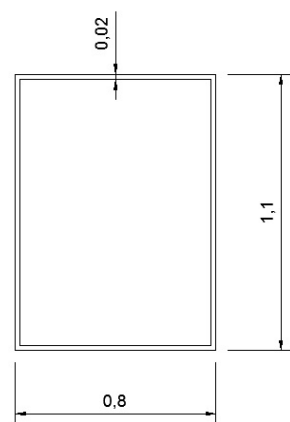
Figura IV: SECCIÓN DE LA VIGA LONGITUDINAL
